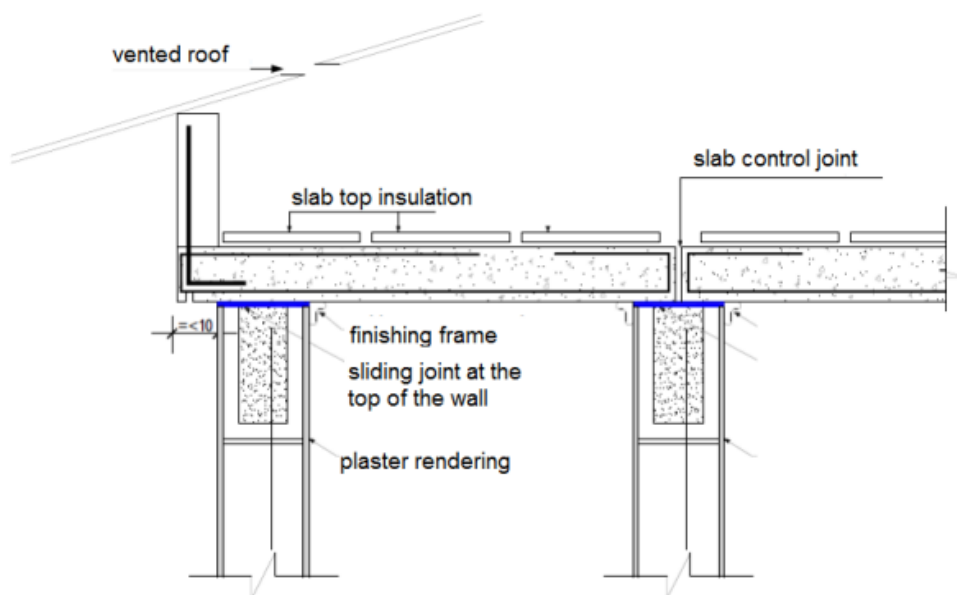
Detalhe da laje de cobertura com canaleta J (isopor e apoio deslizante)
